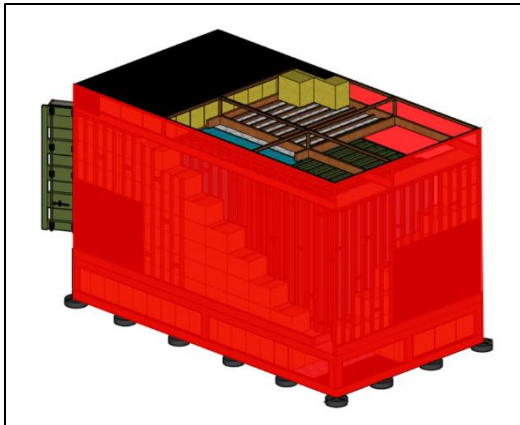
Vue en trois dimensions de la surface à barder sur le conteneur
